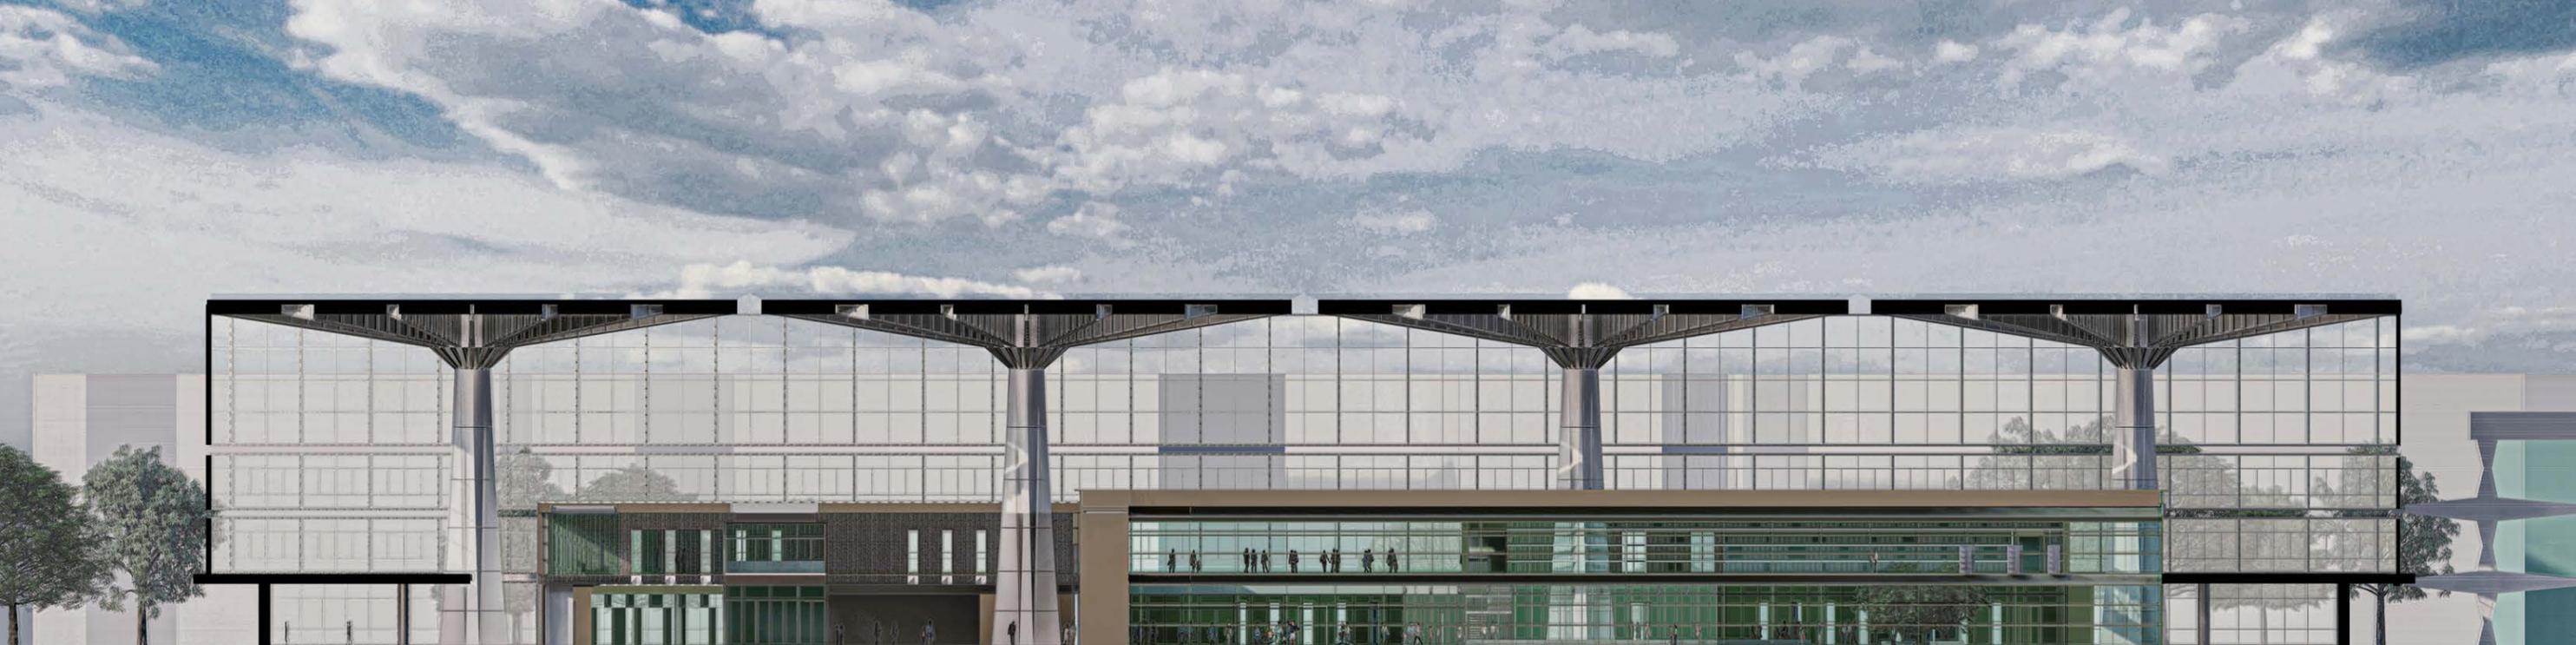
Sezione rappresentate il progetto proposto e il suo rapporto con la struttura di Nervi, elaborato degli autori.
